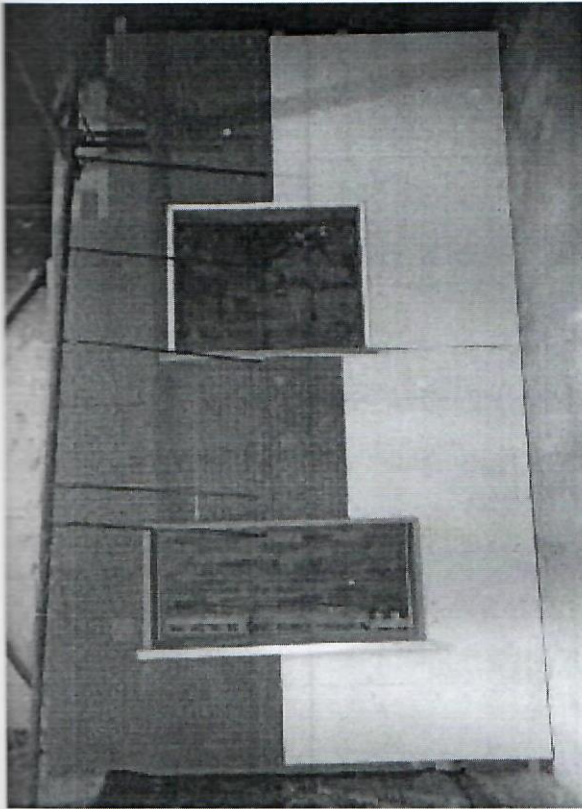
Фрагменты образца фасада до испытания по ГОСТ 31251-2008.
